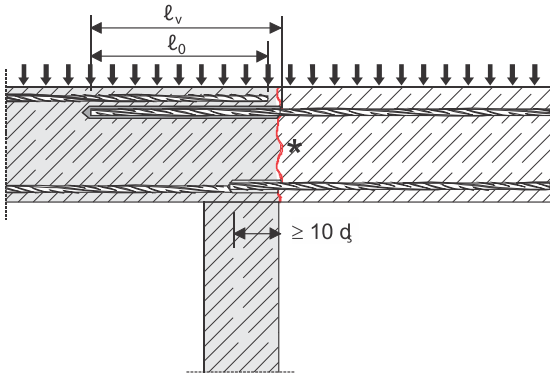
Ancrage direct d'armatures en extrémité de dalles ou poutres, simplement appuyé.
